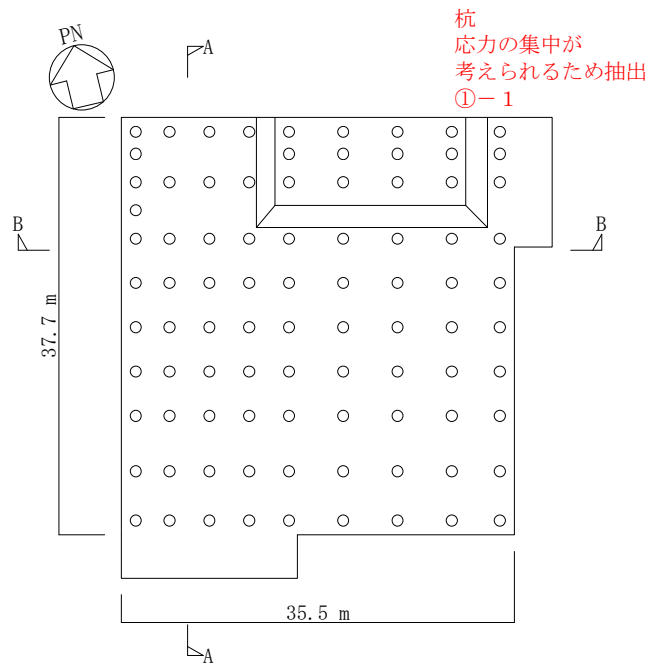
緊急時対策所建屋の概略平面図 (EL. 20. 8m)
